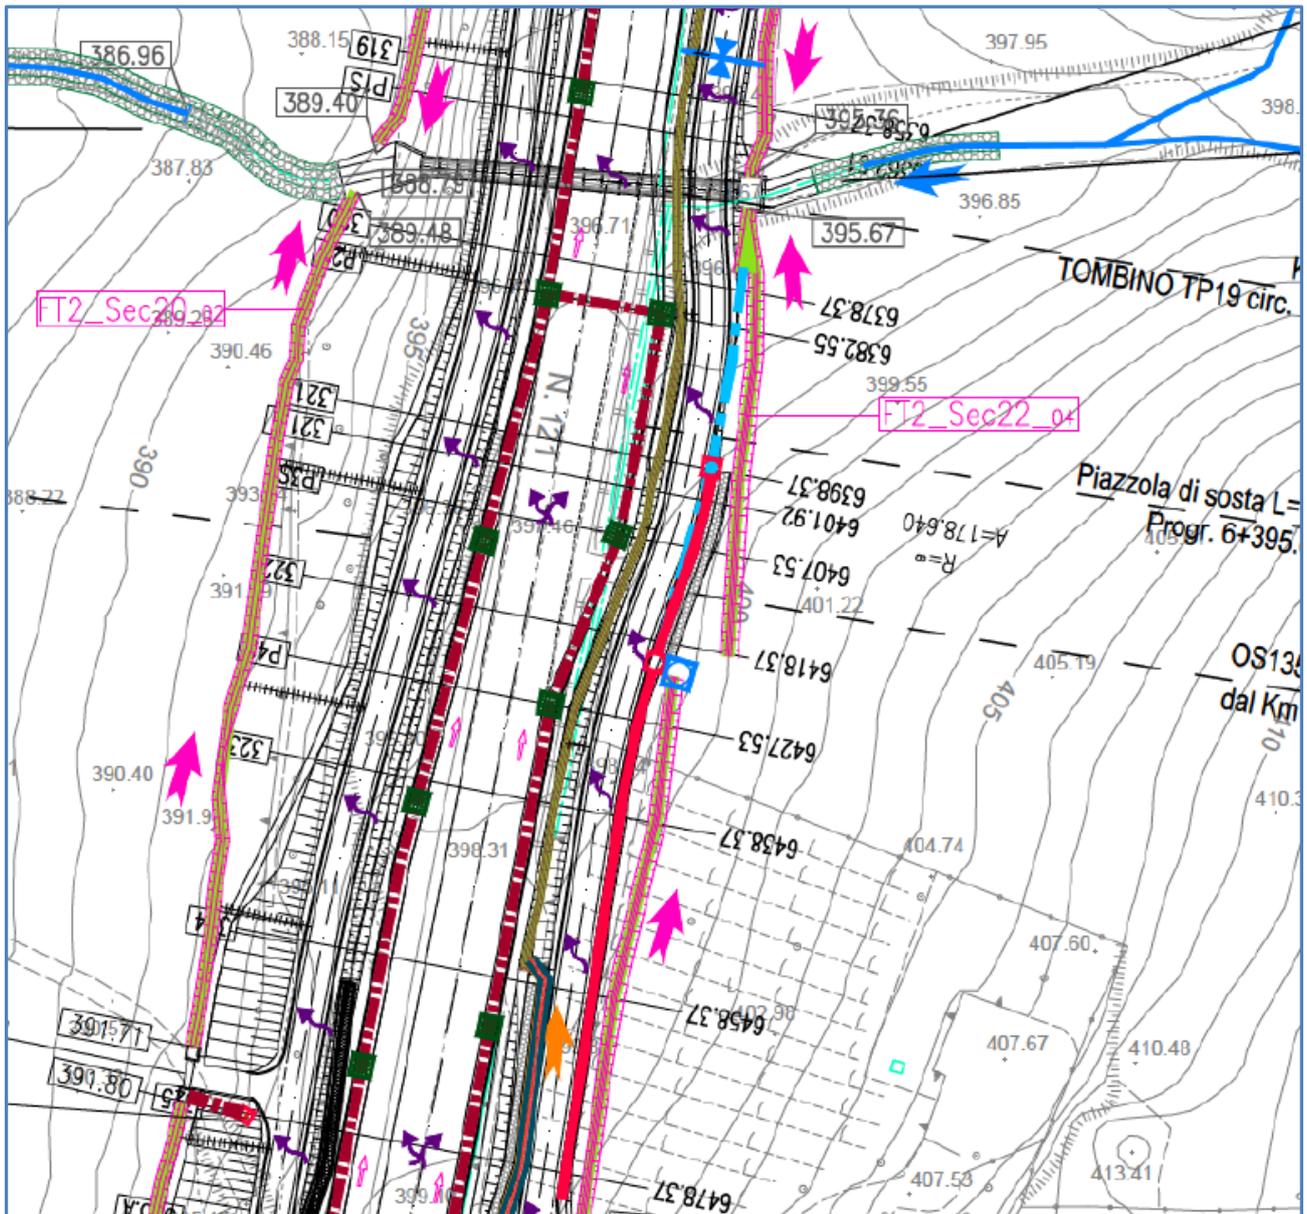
Stralcio della planimetria idraulica aggiornata.
